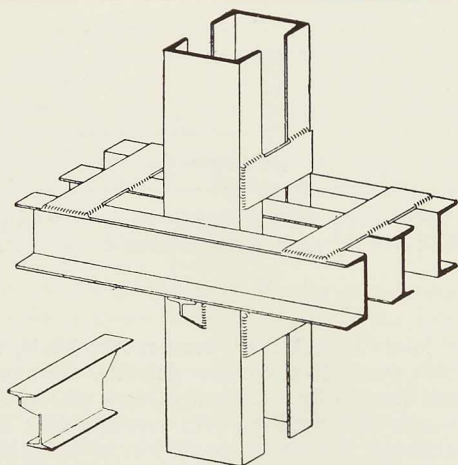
Assemblage d'une poutre longitudinale à une colonne.
